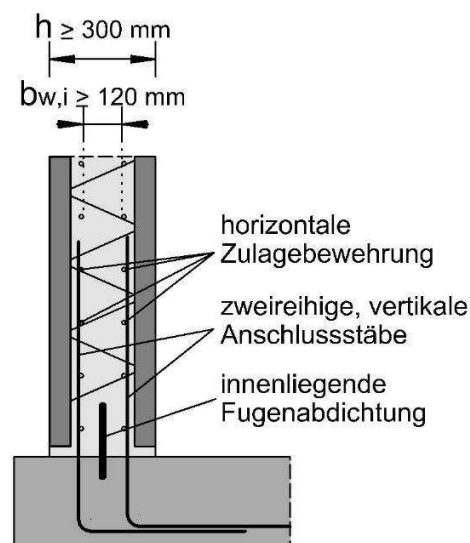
Elementwand mit Wanddicke von 300 mm und innenliegender Fugenabdichtung und Bewehrungslagen im Ortbeton mit dem Sonderfall horizontaler Bewehrungsstäbe
